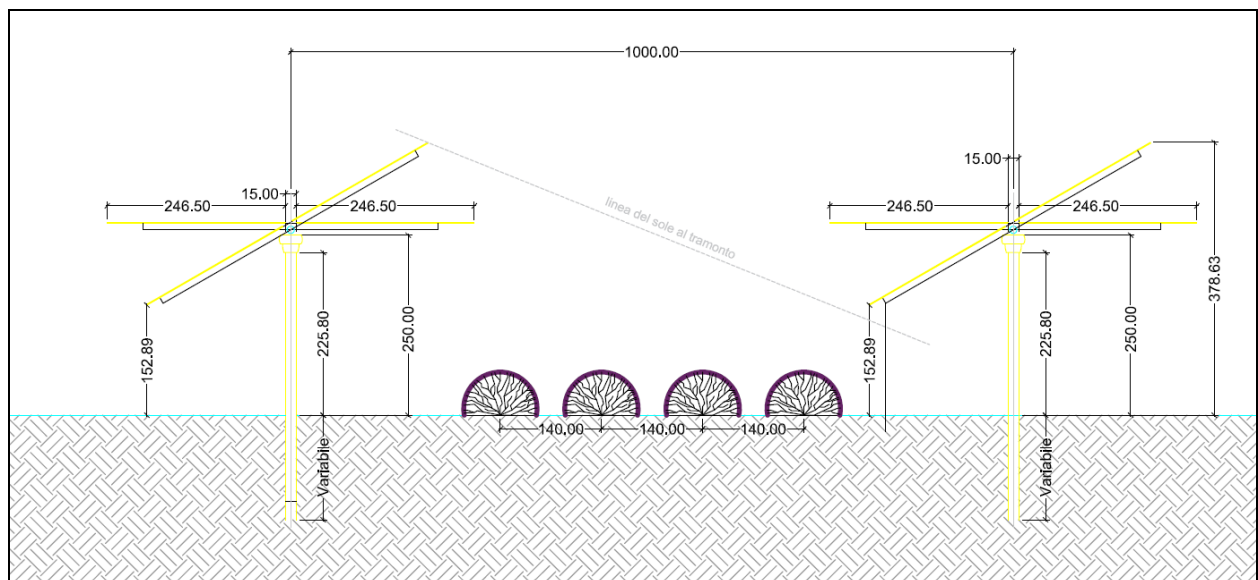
Schema di impianto della Lavanda nell'interfila dei pannelli
